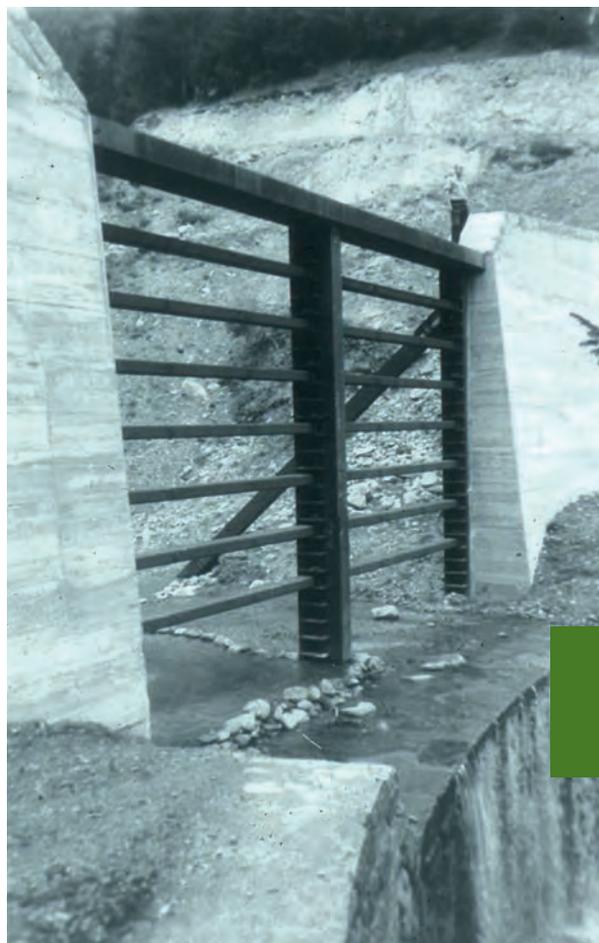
Pillbachsperre, Gemeinde Pill, Sperrenbauwerk mit großen Schäden
